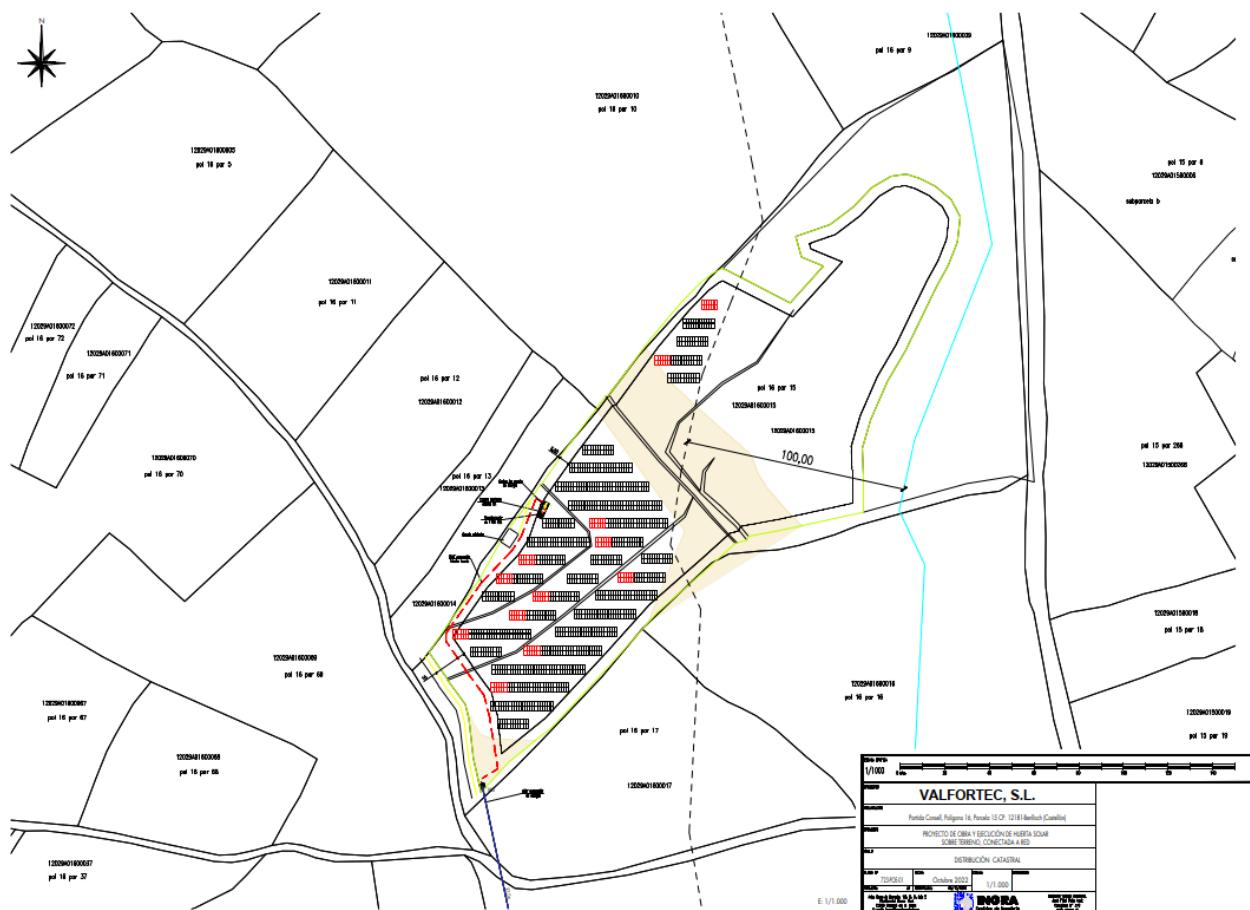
Extracto del plano de distribución de planta de la propuesta inicial
